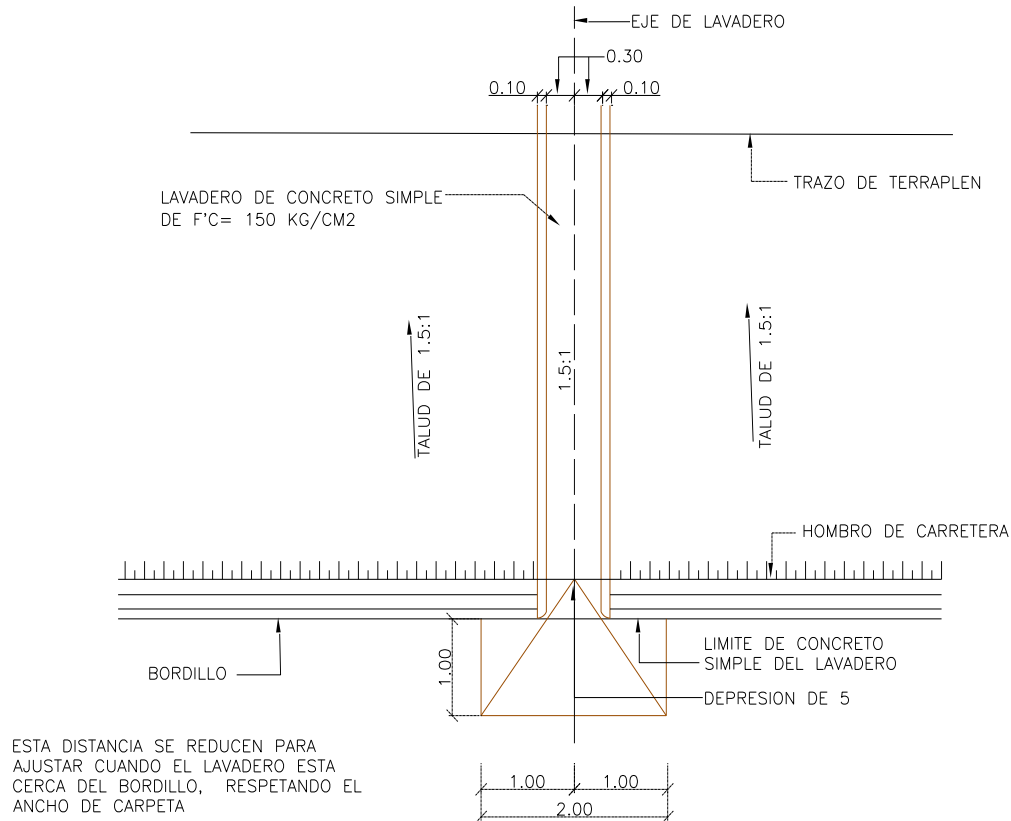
Planta de Lavadero en su colocación sobre talud y hombro de camino
